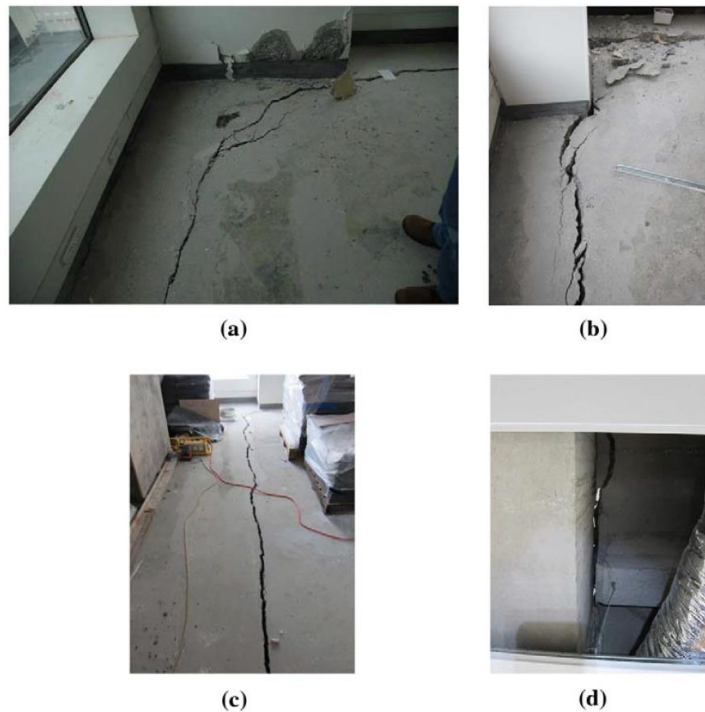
Daños en sistemas de piso. (a) columna de esquina; (b) a lo largo del perímetro del marco; (c) grietas junto a vigas interiores; (d) vista inferior mostrando el ala colgada de losa doble “T”.
